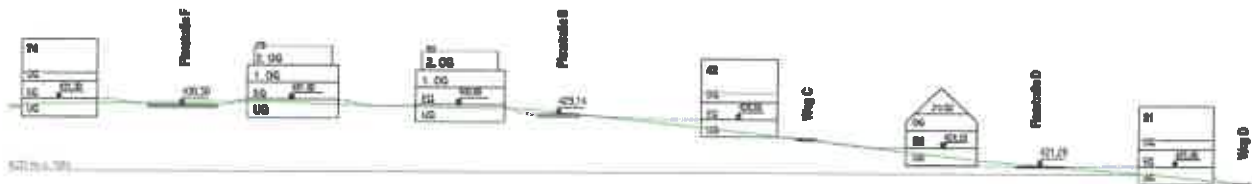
Geländeschnitt Nord-Süd durch die Planstraße F, B und D, o.M.
